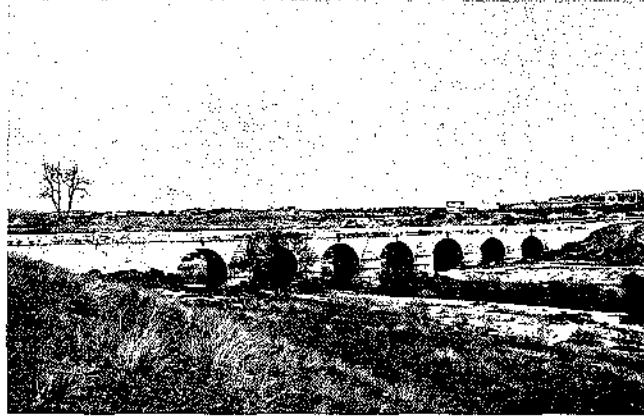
Puente del Retamar. Vista general. — Fig. 7: Puente del Retamar. Pilas centrales.
